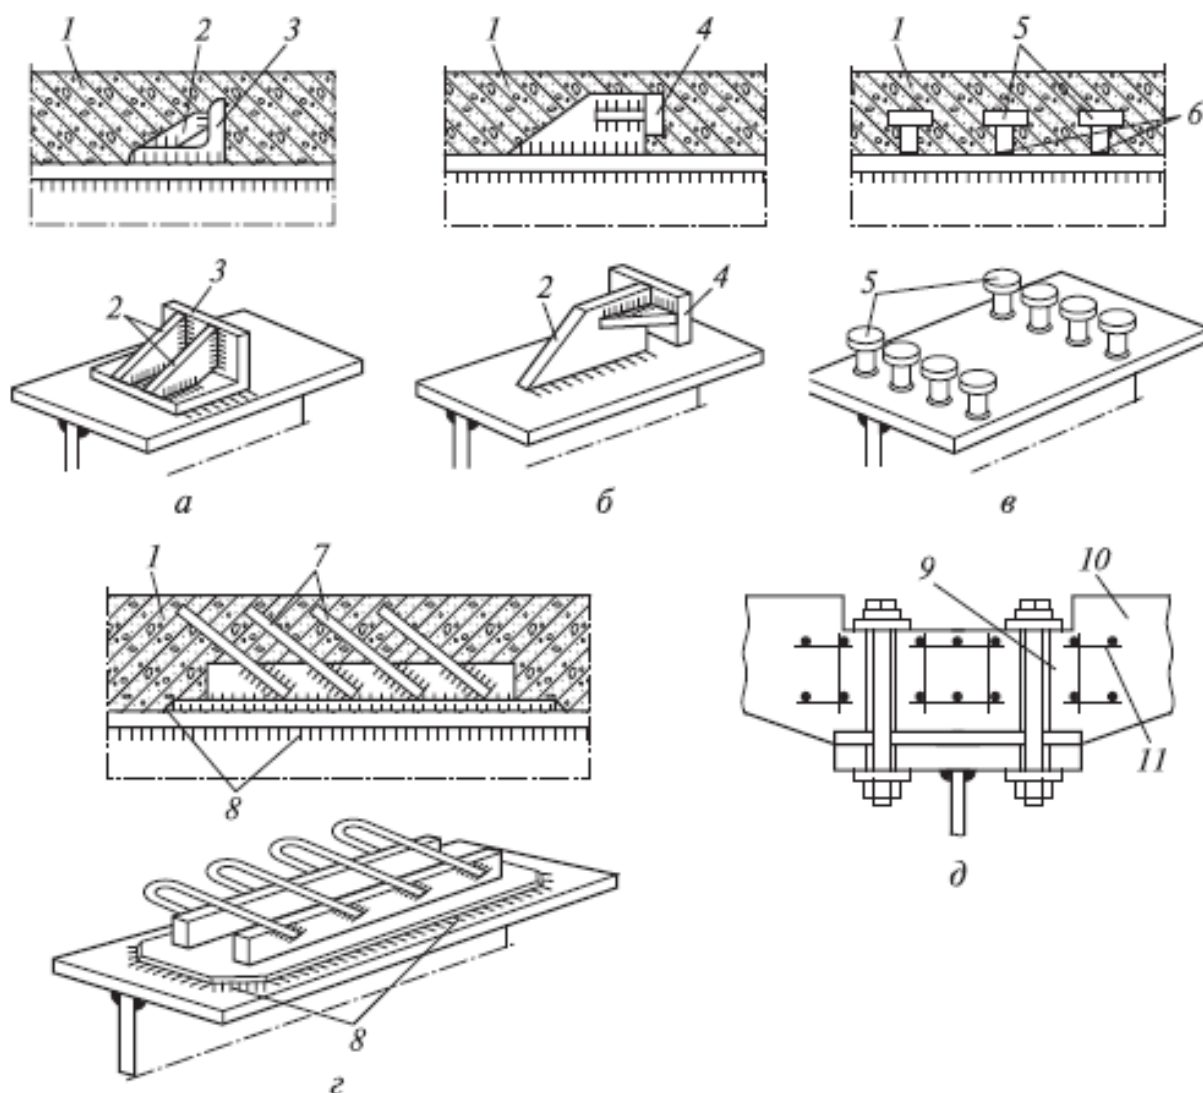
Способы соединения железобетонной плиты с металлическими балками:
